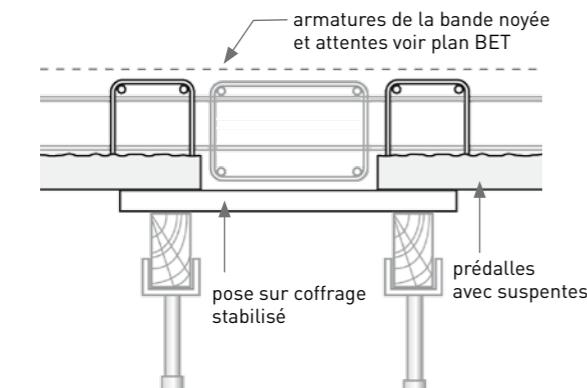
PRÉDALLES SUSPENDUES SUR BANDE NOYÉE OU SUR POUTRE VOILE SANS RETOMBÉE
